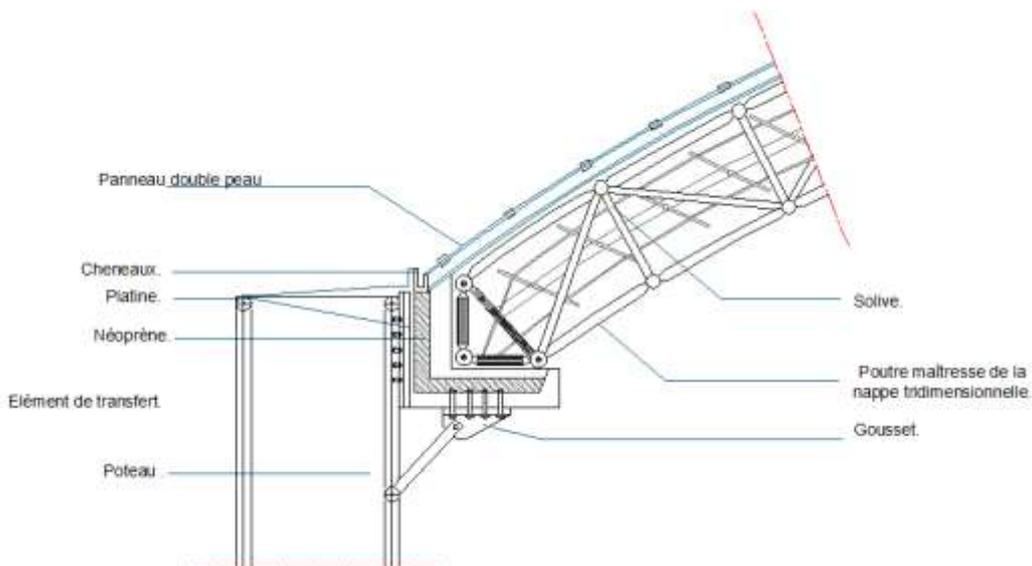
Détail de la toiture et de l'assemblage avec le poteau
